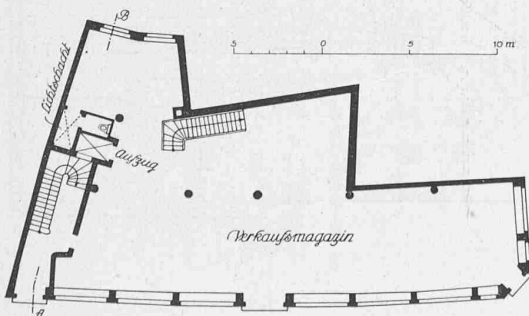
Grundriss des Kaufhauses Gebr. Hess A.-G.
